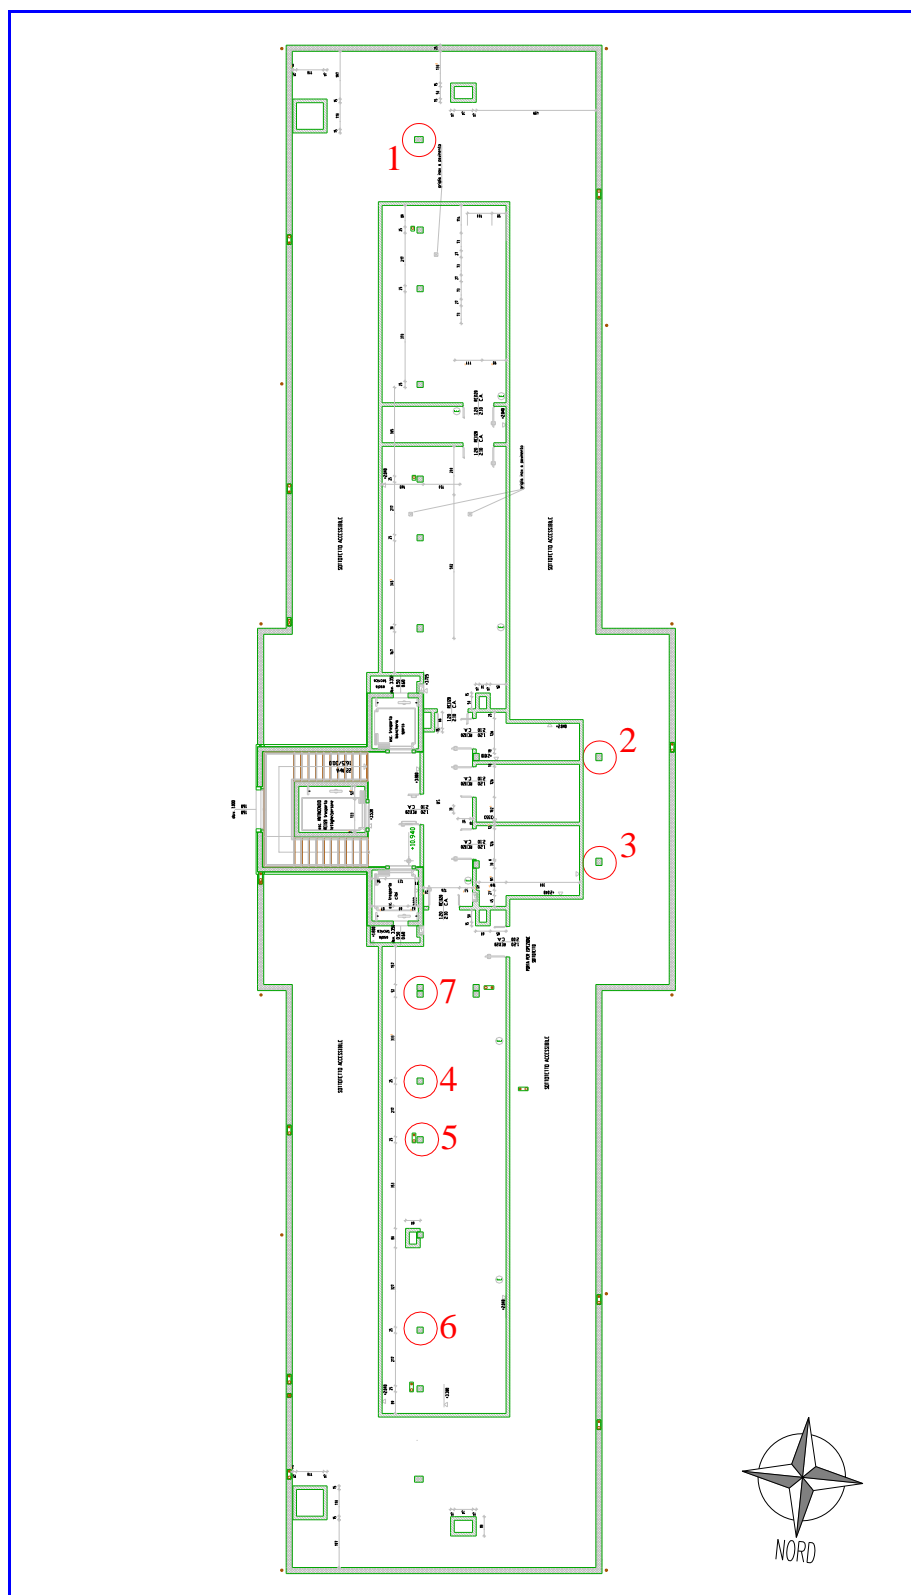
Planimetria sottotetto con ubicazione punti di indagine
